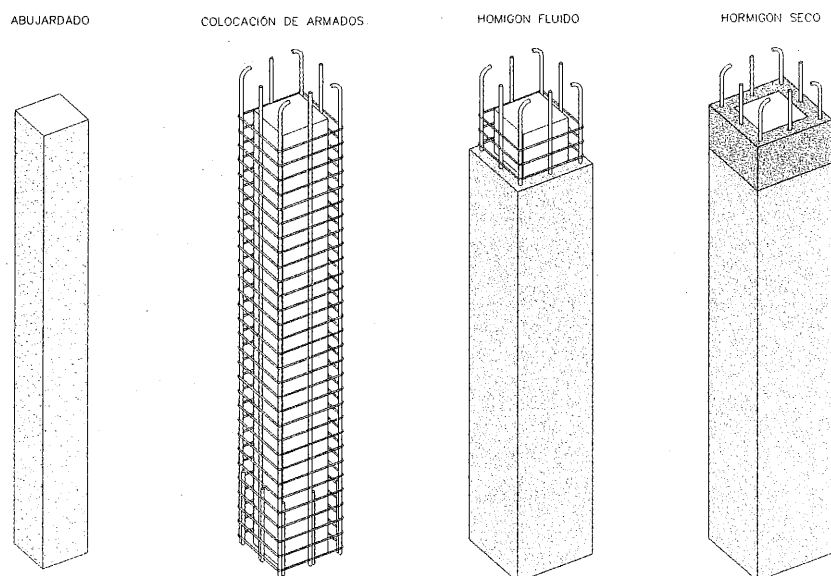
12. Refuerzo de pilar con hormigón armado.
